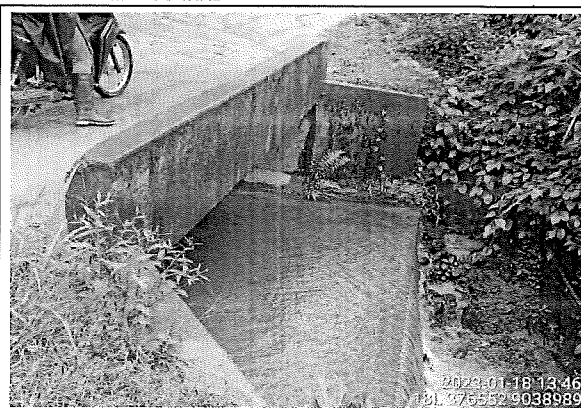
Alcantarilla de concreto en buen estado y buen funcionamiento ubicada en la progresiva 6+798.
